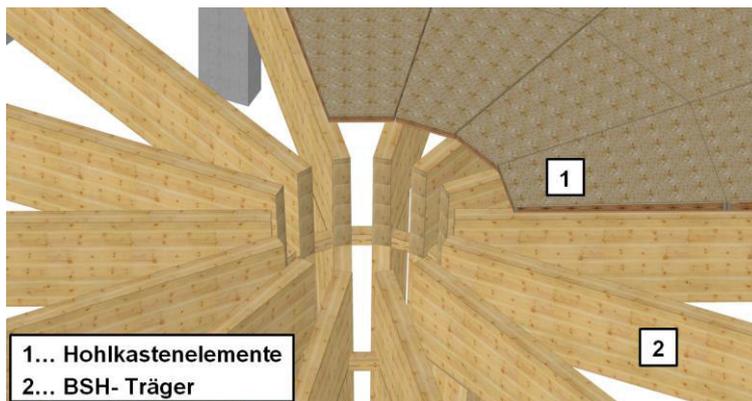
3D-Holzbauplanung der Hohlkastenelemente auf Brett-schicht-holzträgern (Projekt B)⁴⁰⁶
